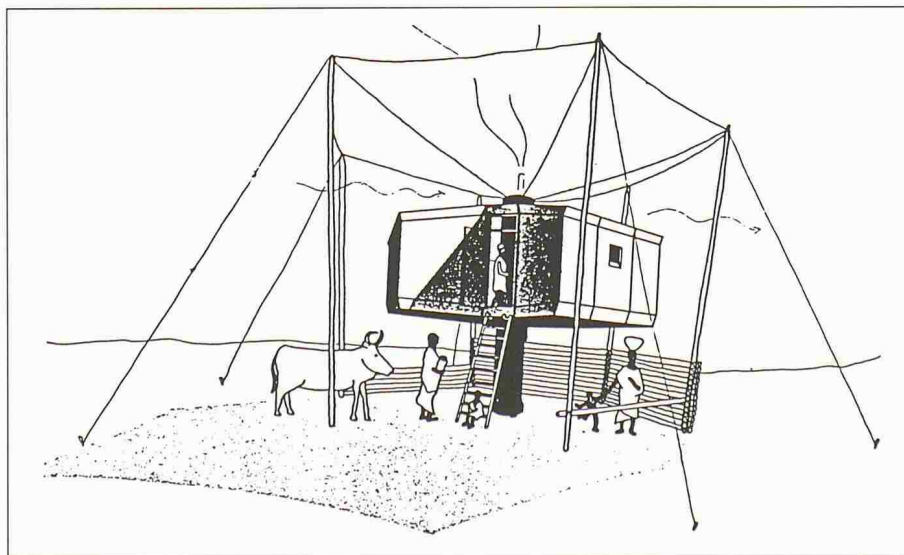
Für den Hausbau werden nachgelieferte Bauelemente an den Installationskern angehängt
